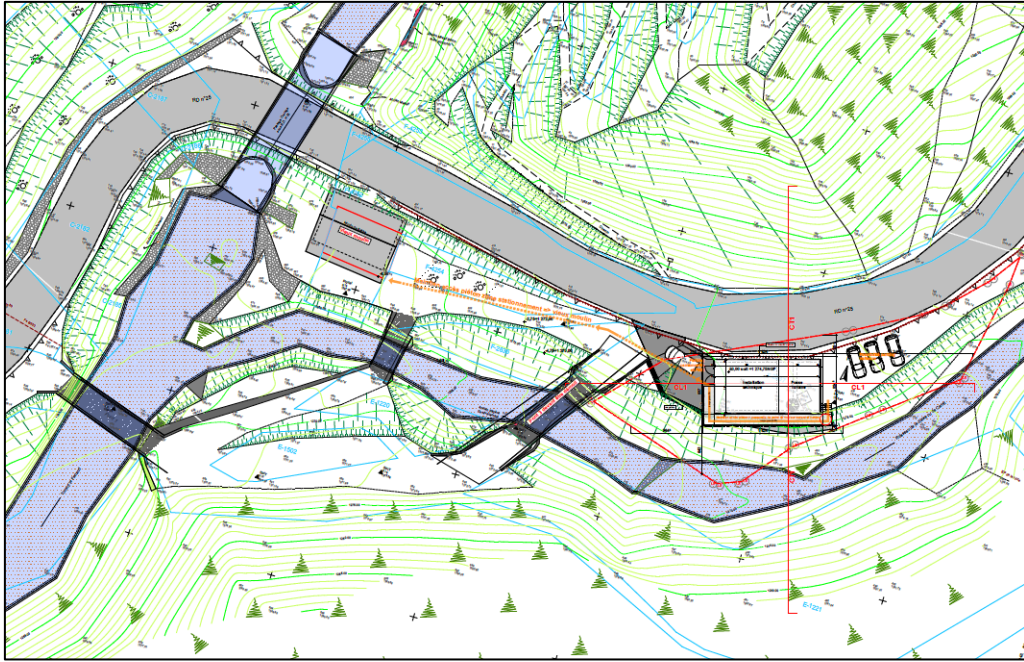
Implantation du bâtiment de la centrale hydroélectrique
